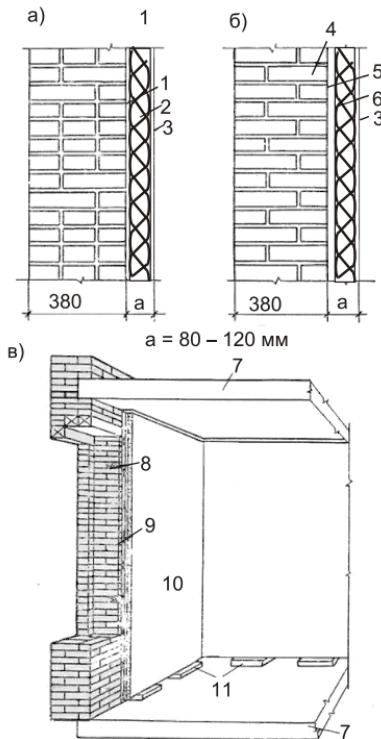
Стены с облицовкой панелями: а) установка утеплителя на растворе; б) то же, на откосе; в) облицовка прокатными панелями: 1 — цементный раствор; 2 — утеплитель; 3 — затирка; 4 — расшивка швов; 5 — воздушная прослойка 20 мм; 6 — утеплитель; 7 — панель перекрытия; 8 — деревянная пробка; 9 — термический зазор; 10 — стеновая панель; 11 — временные подкладки
